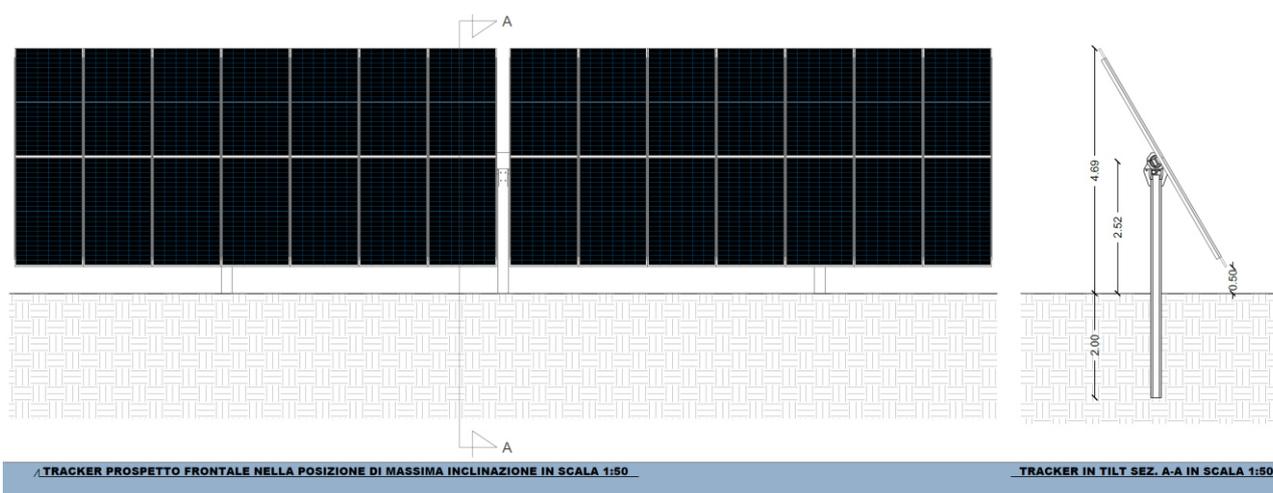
Tracker 2P in posizione di massima inclinazione - Vista Longitudinale e Sezione Trasversale
